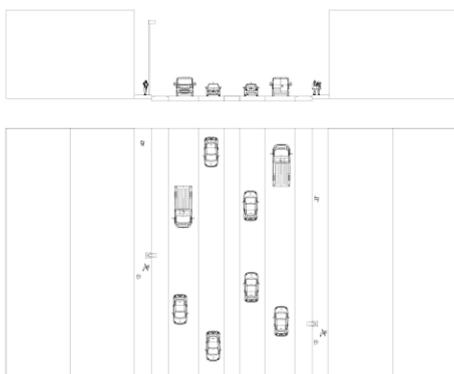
Sezione e Pianta esemplificativa, Pre e Post intervento di Via Bologna
